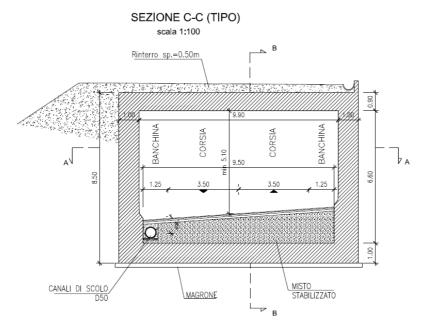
sezione trasversale galleria scatolare GA03 da 8.5m
